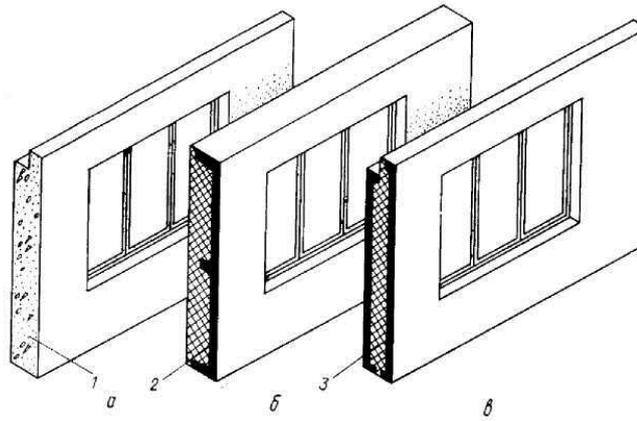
Наружные несущие стеновые панели: а – однослойная; б – двухслойная; в – трехслойная; 1 – материал, обладающий необходимой несущей и теплоизолирующей способностью; 2 – несущий слой; 3 – теплоизолирующий слой.
